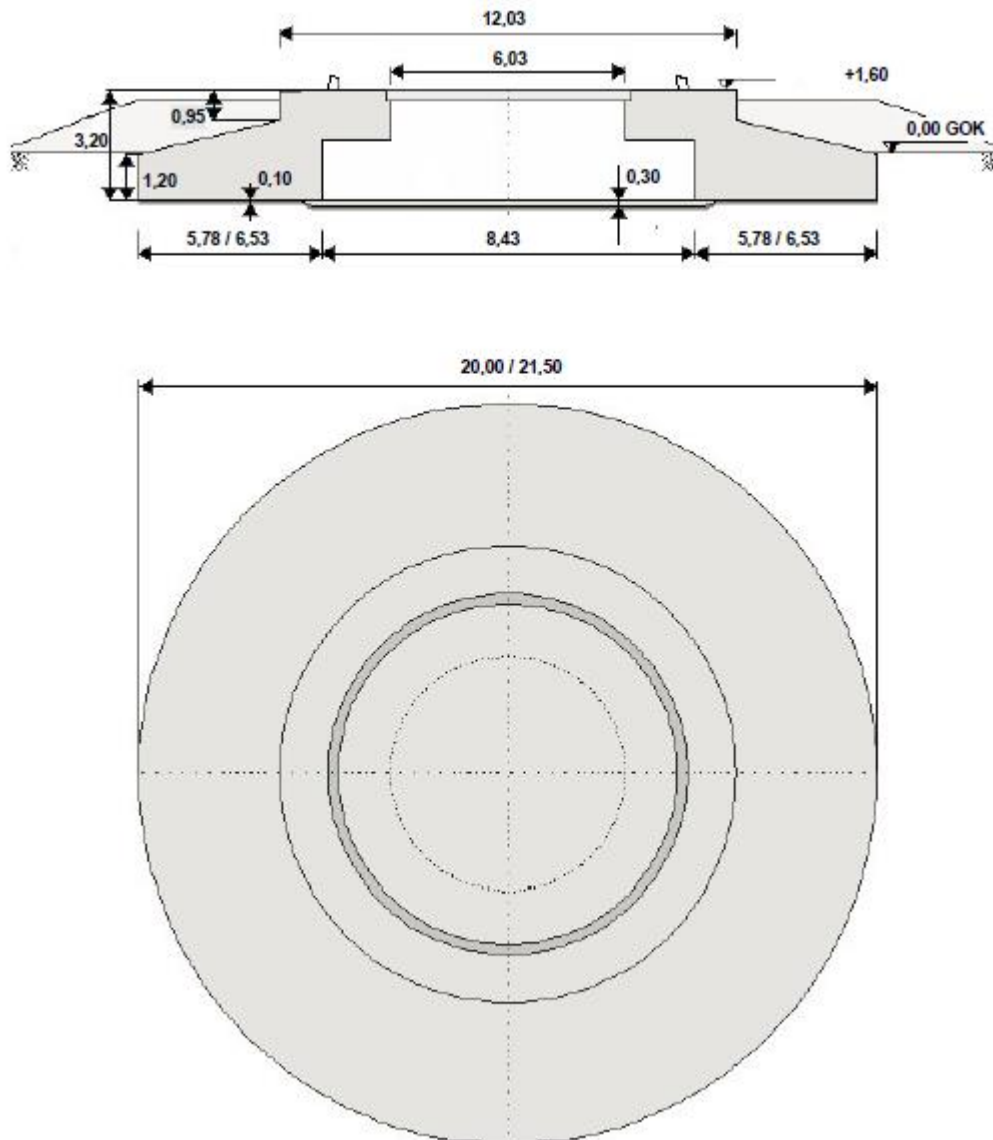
\_Fundament N 117\_Quelle Nordex: Fundamentbeschreibung [Abschn. 3.1.3 BImSch-Antrag]
